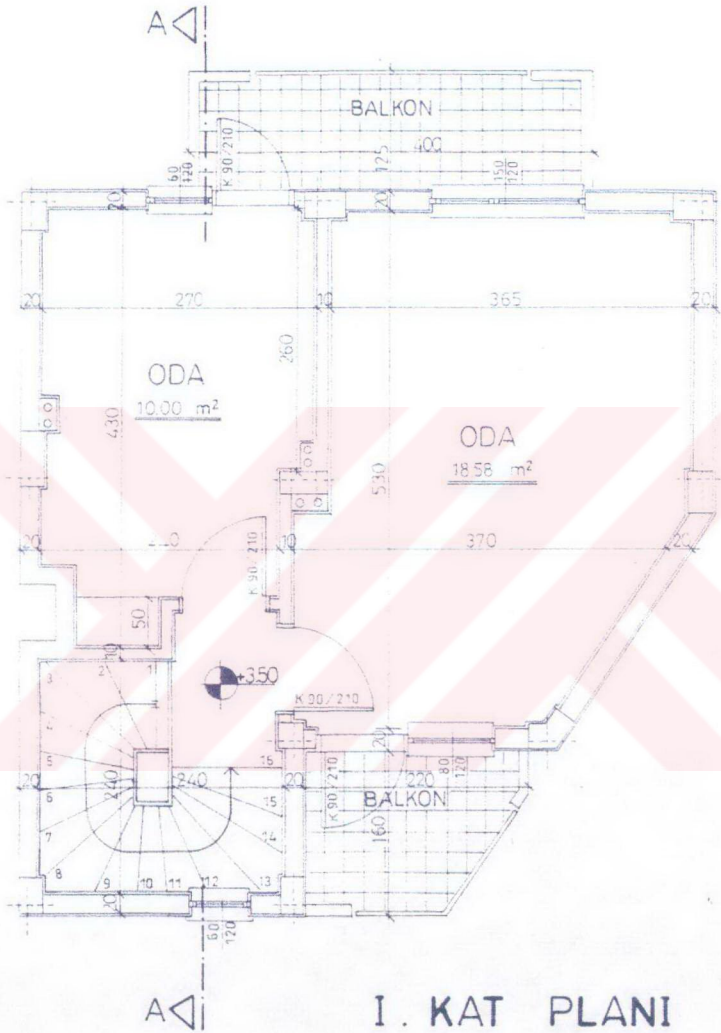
Gecekondu önleme bölgesindeki konutların I.kat planı
